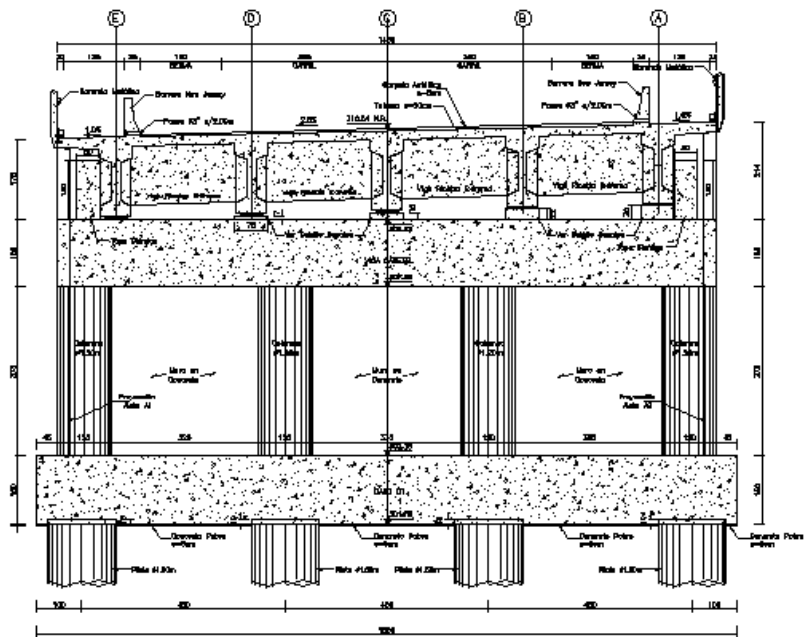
Geometría apoyo eje 1 – Puente San Pedro
